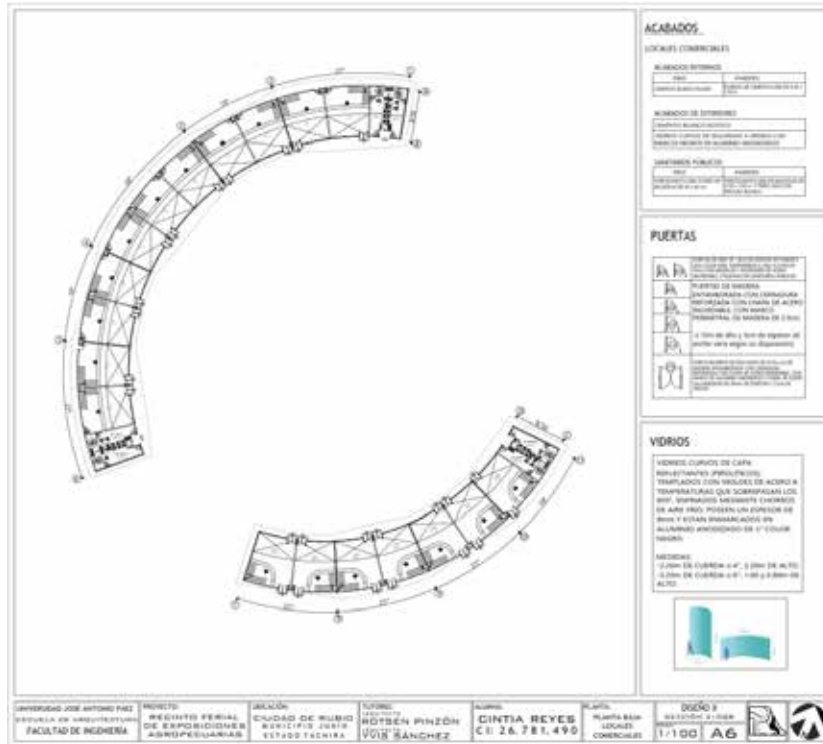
Plano A6, Planta baja de locales comerciales. La Autora (2020).
